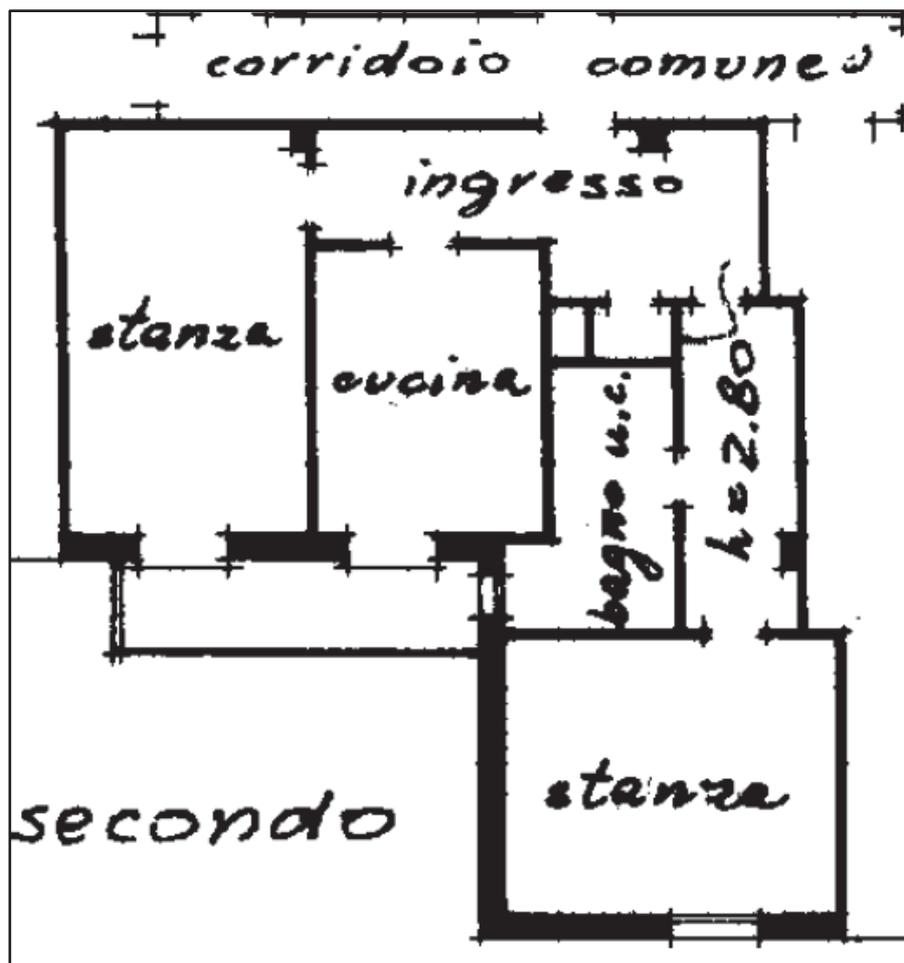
Pianta dell'appartamento (tratta dalla planimetria catastale)
